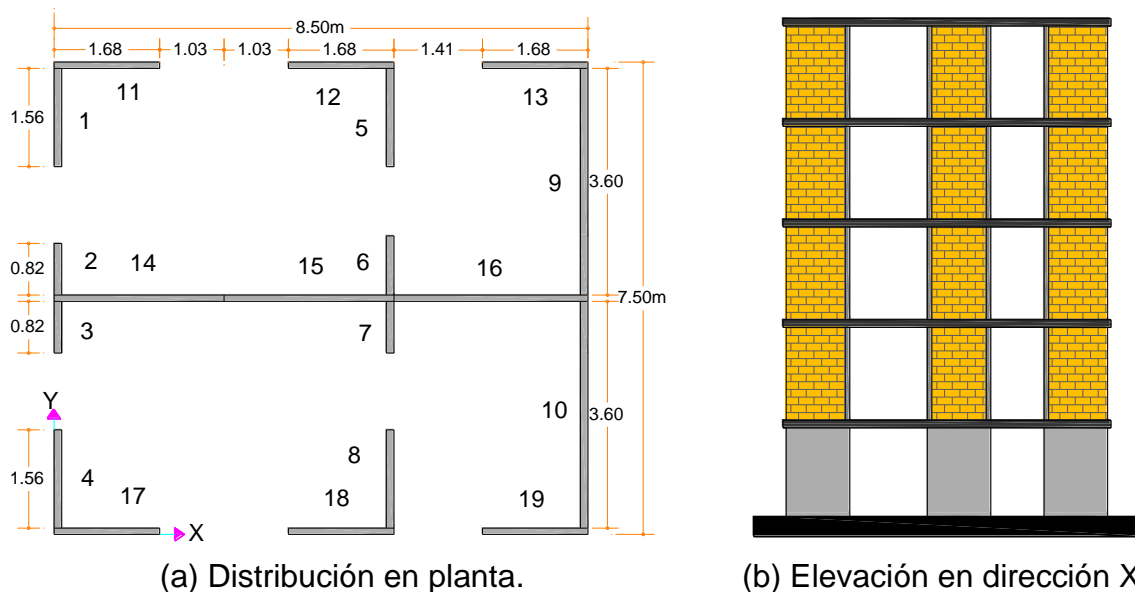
Planta y elevación de estructura de concreto reforzado y mampostería confinada.
